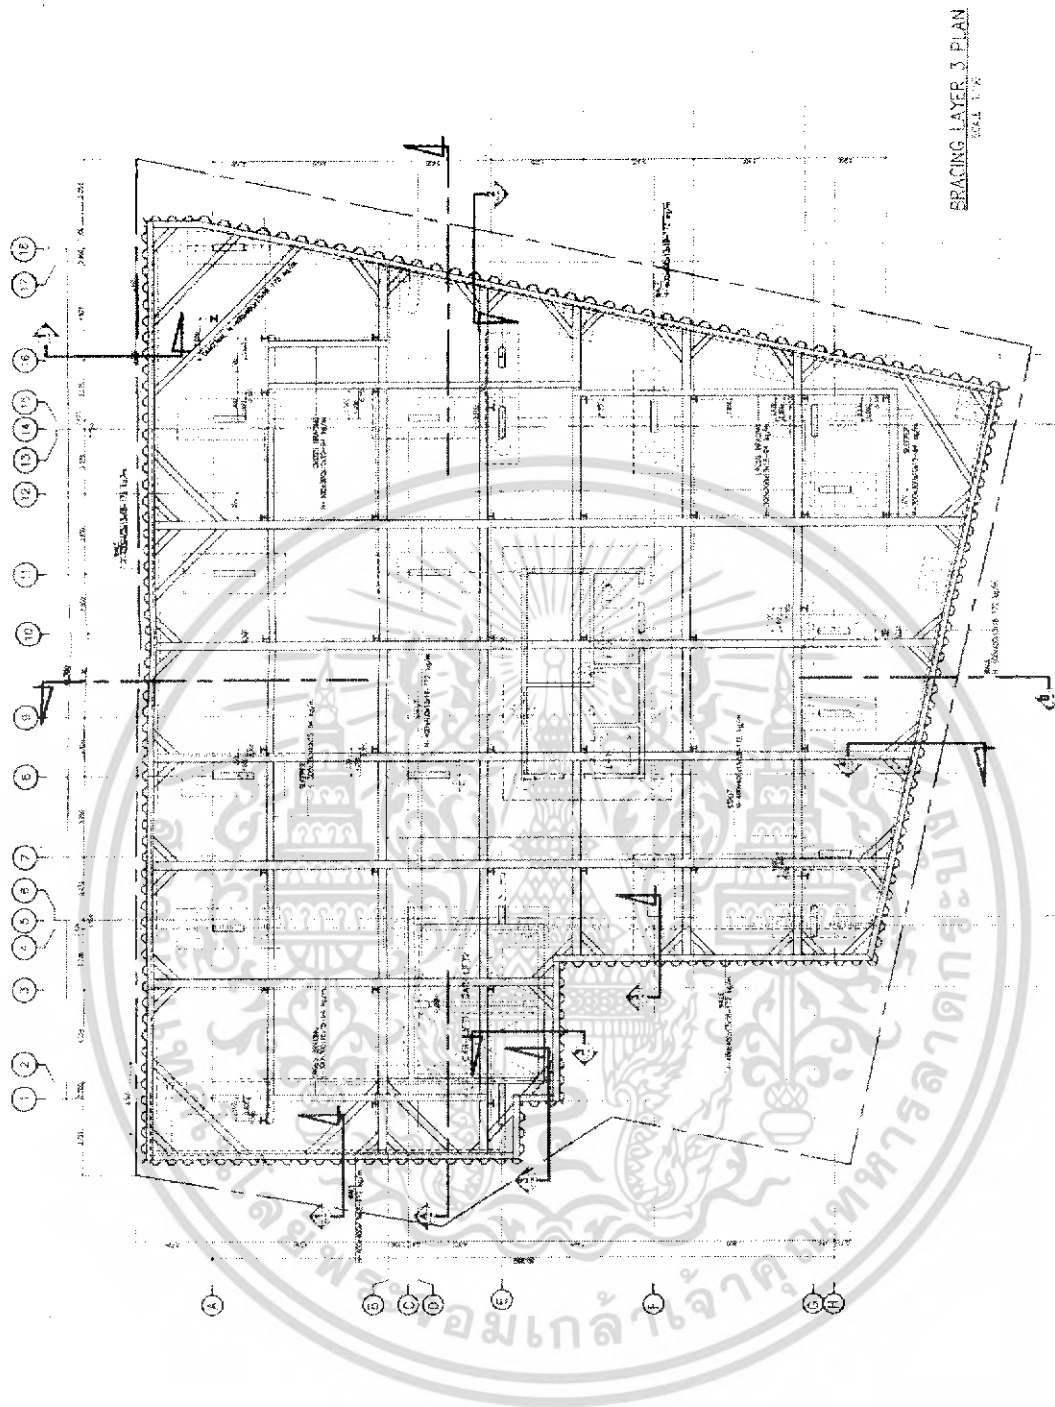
แสดง Lay out ของโครงการ Oak Wood Boutique Apartment
